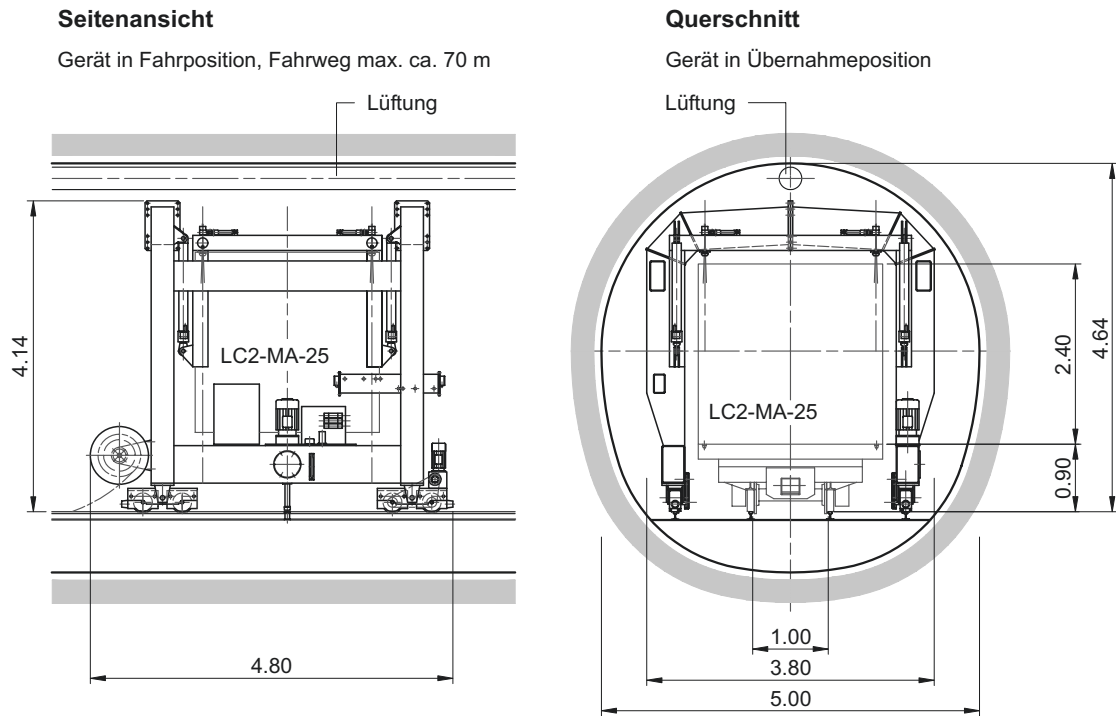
Einlagerungsgerät für LMA-2 – Seitenansicht und Schnitt durch den Lagertunnel LMA-2 – Abmessungen in m
